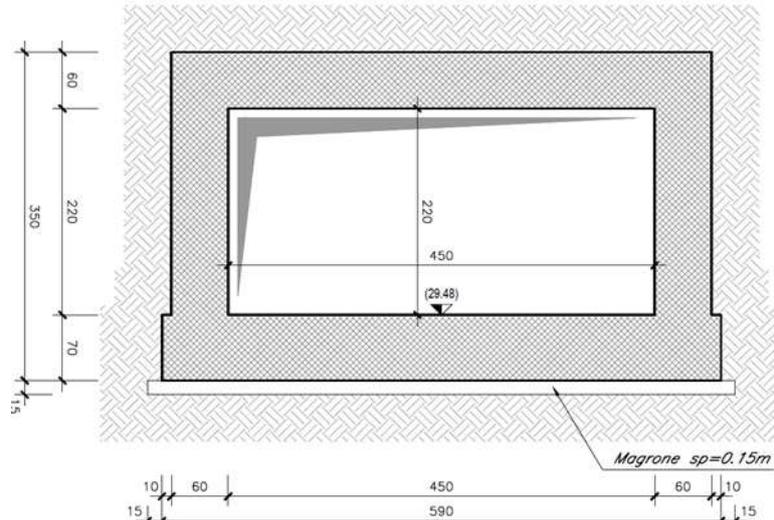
Sezione trasversale del tombino scatolare sull'attraversamento ferroviario alla pk 7+859,01.
